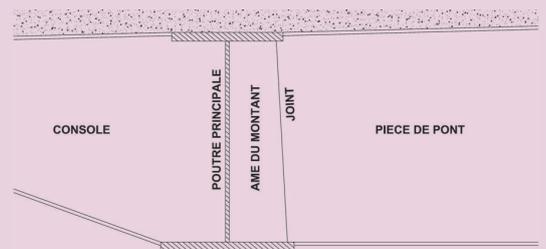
Liaison poutres principales/pièces de pont (cas particulier)
